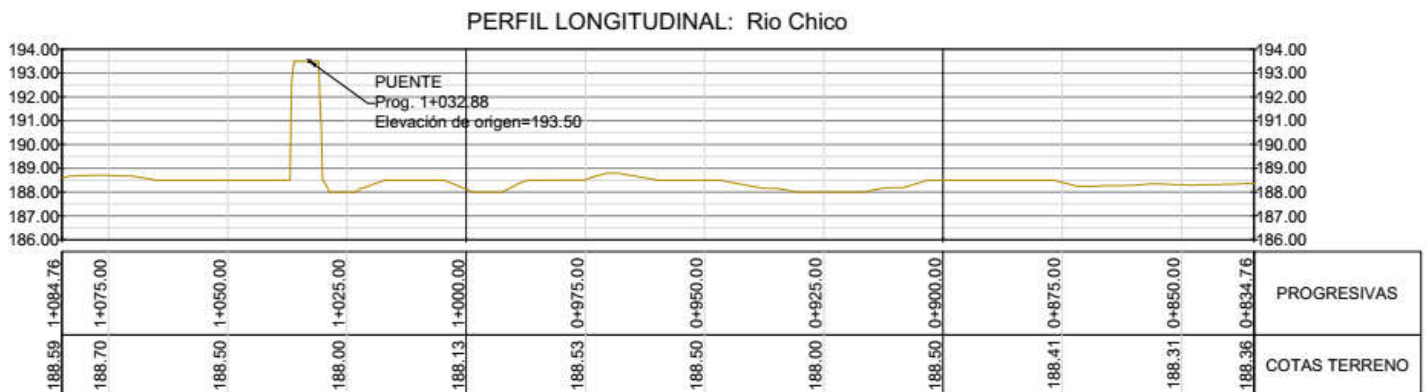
Perfil longitudinal en la zona del puente (Autodesk Civil 3D).
